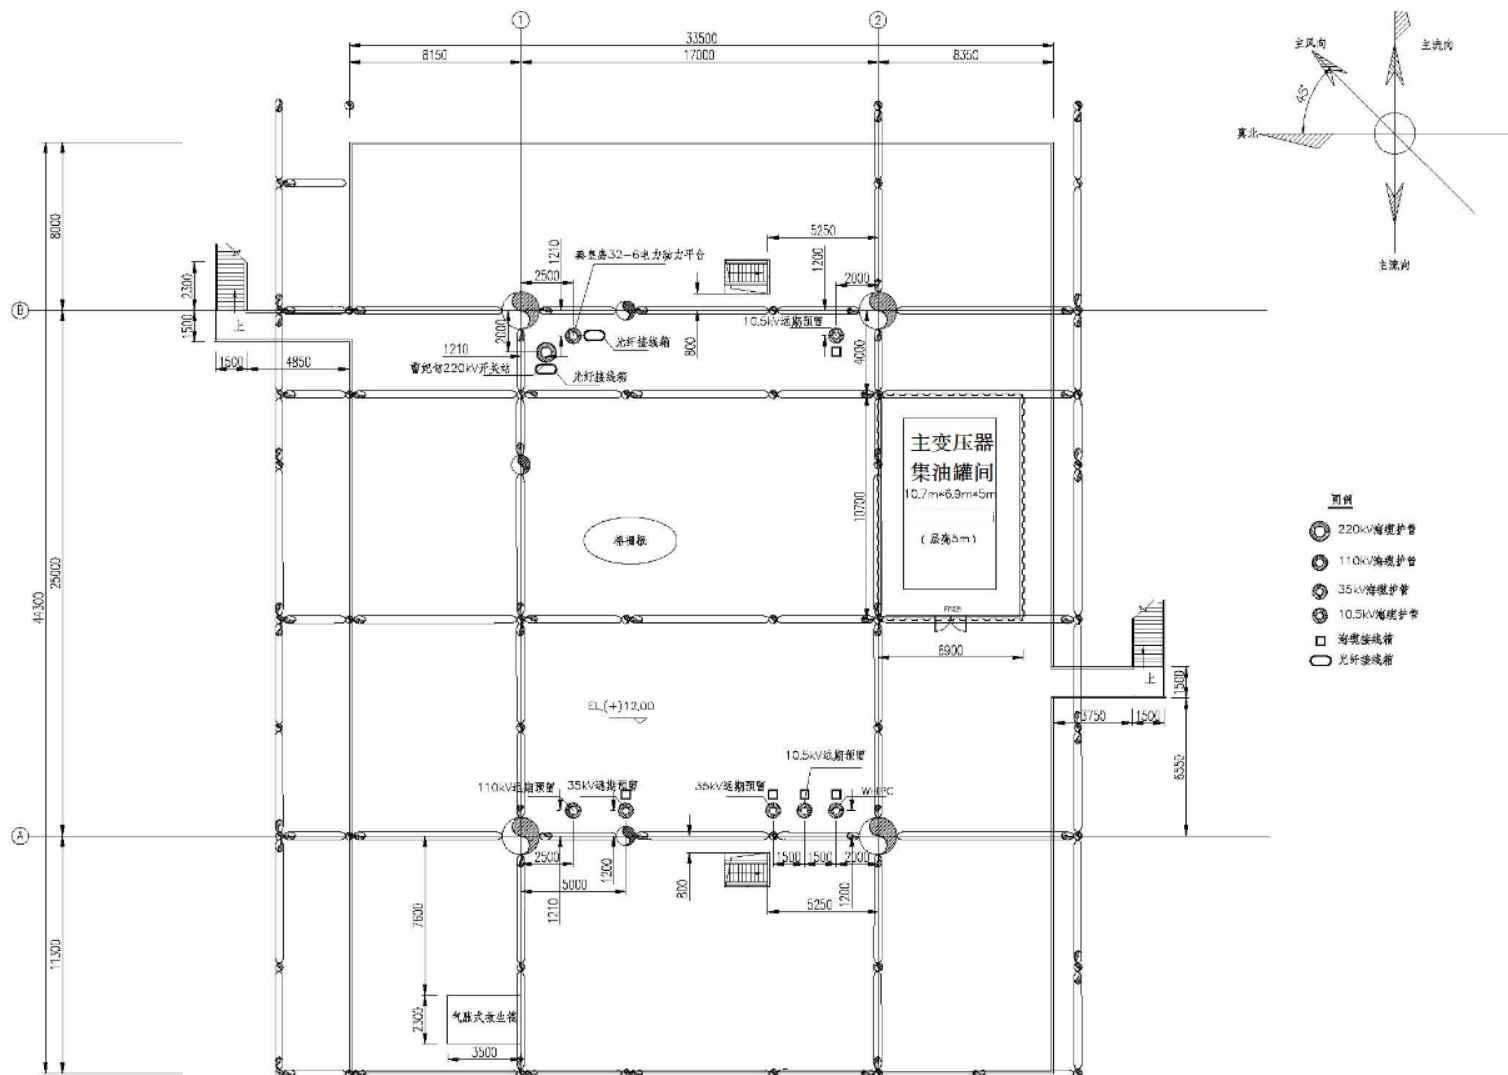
CFD11-1EPP 平台工作甲板平面布置图
